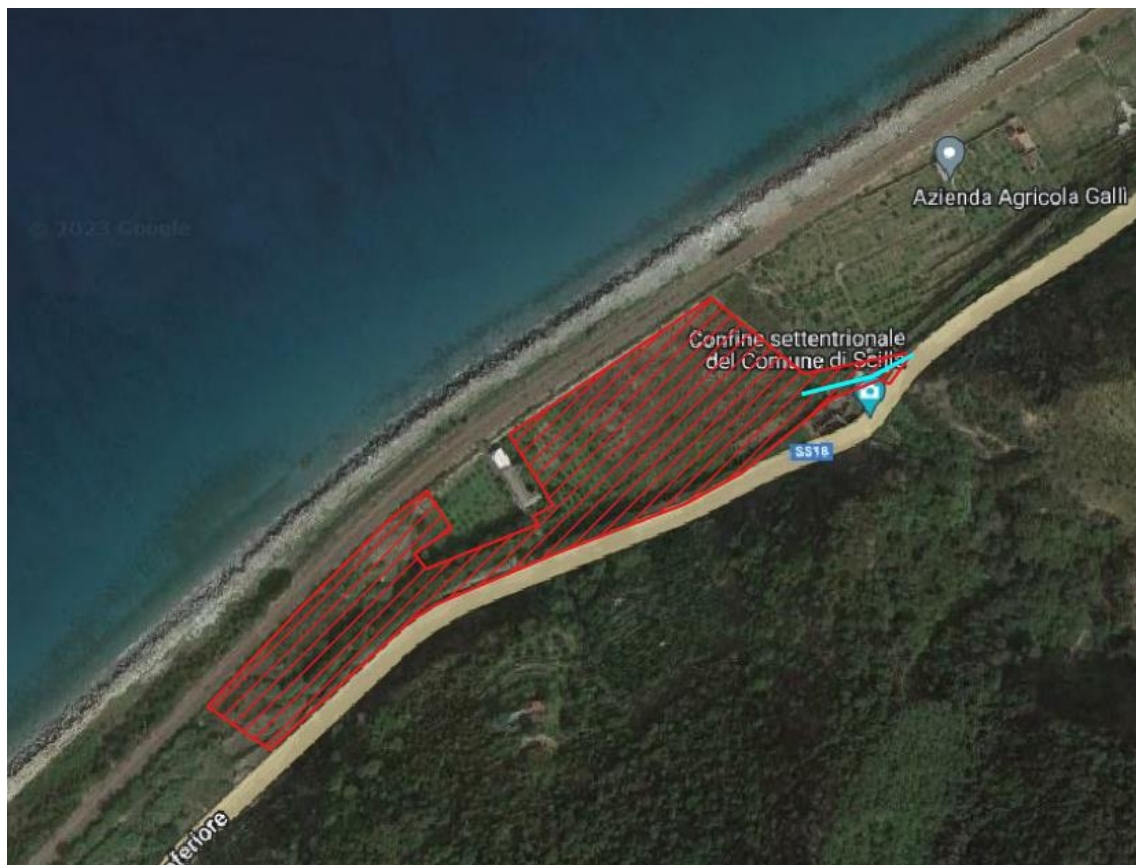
Area cantiere galleria accesso (viabilità da creare 1 in ciano)
